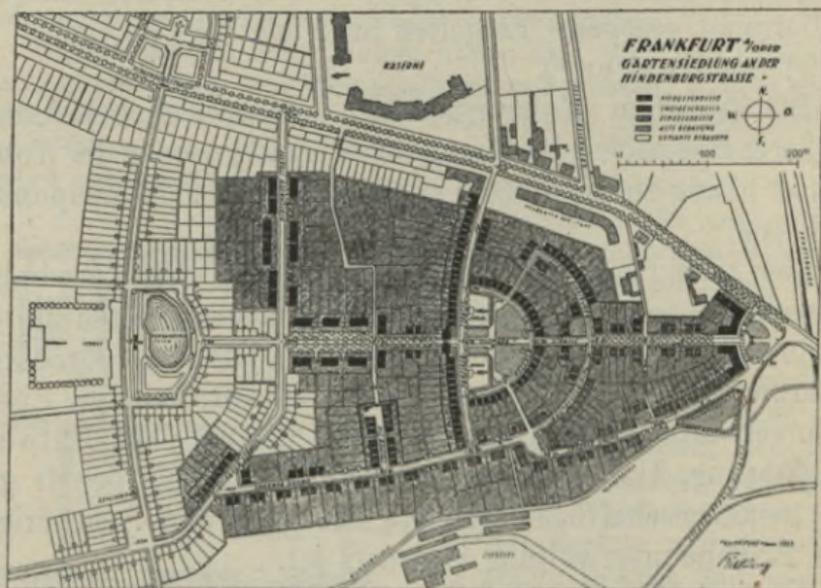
Reichsbahn-Garten-Siedlung Paulinenhof bei Frankfurt/Oder. Lageplan. M. 1 : 6200 (etwa).
